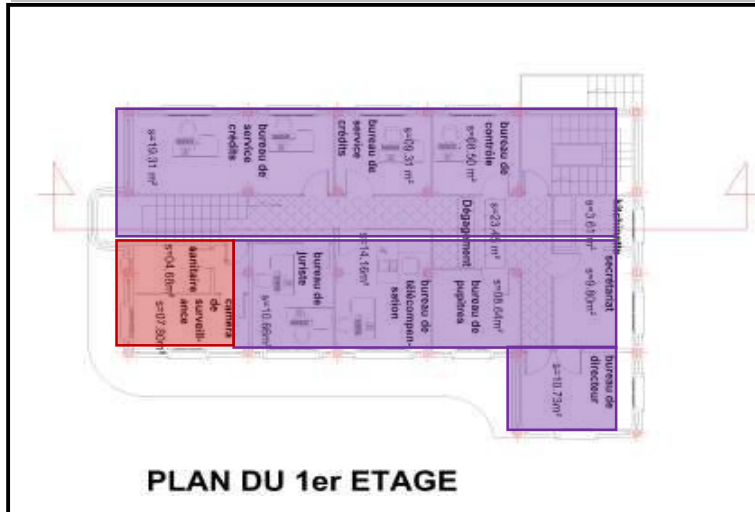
Plan 1 ier étage source : Banque CPA Blida.
